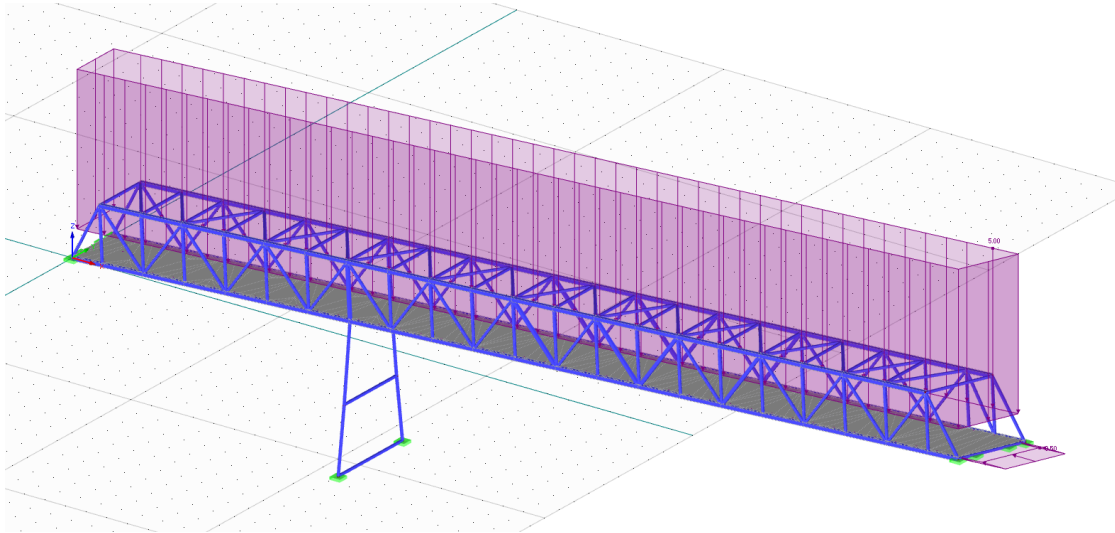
Vista general del modelo estructural con las cargas q y Q_{hk} correctamente definidas.
